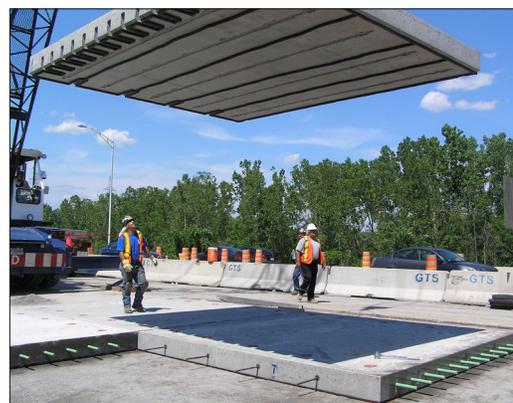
Utilisation de dalles préfabriquées lors de la reconstruction – projet autoroute 13, à Boisbriand, en 2008
